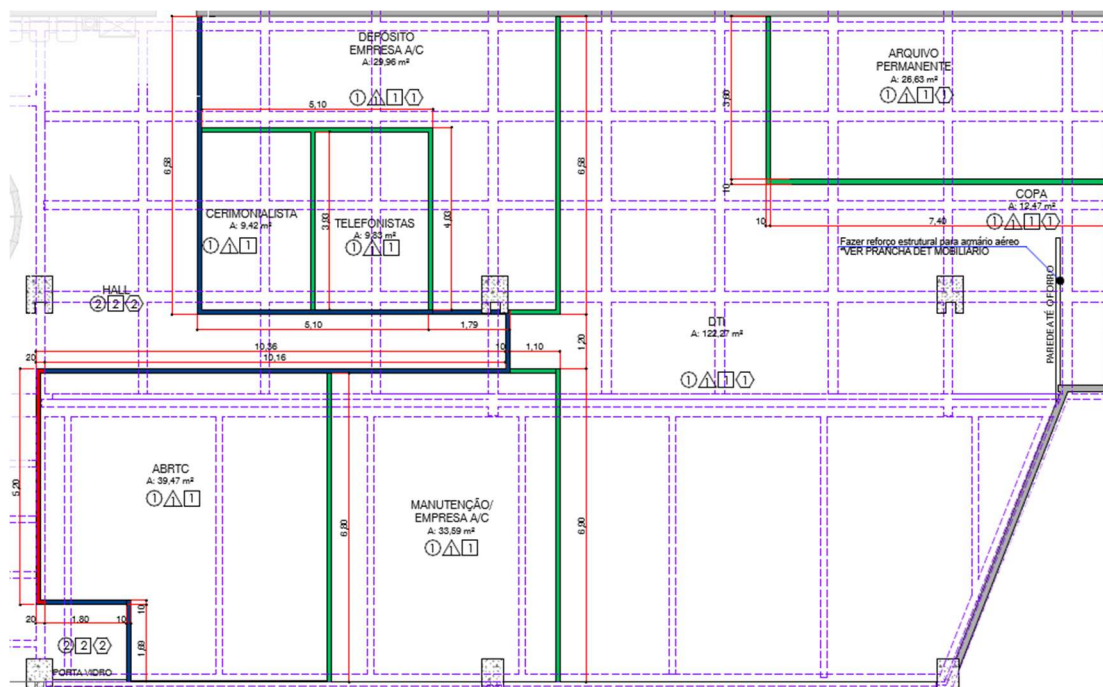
Disposição das paredes de Drywall Térreo/1º andar
